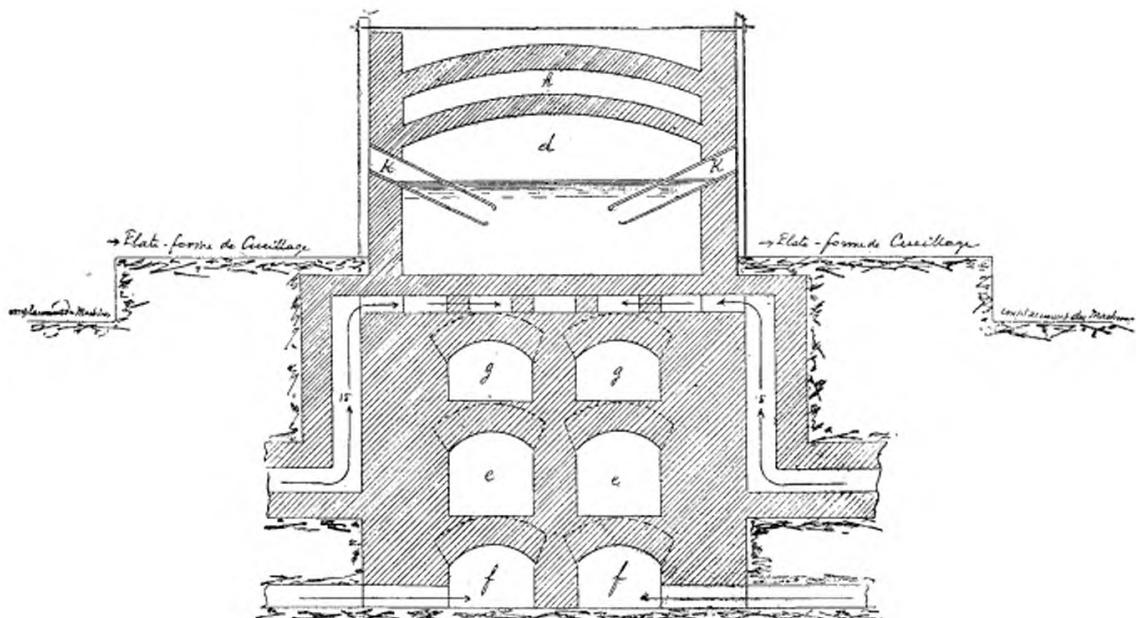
Coupe transversale par les ouvreaux de cueillage laissant voir en même temps les conduits 15 dans lesquels l'air s'élève pour pénétrer derrière l'autel sous la sole du bassin.
